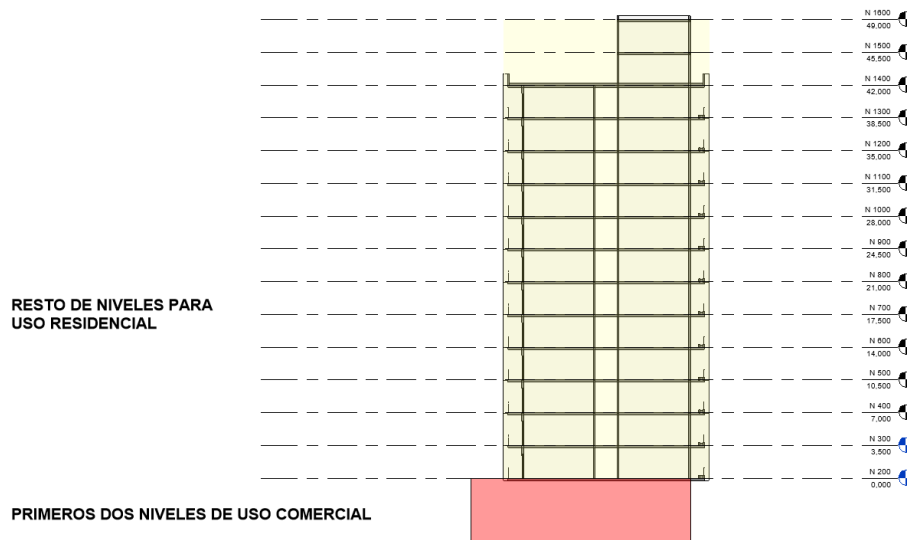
Edificios Residenciales con planta baja comercial y aceras caminables | Elaborado por: El autor
